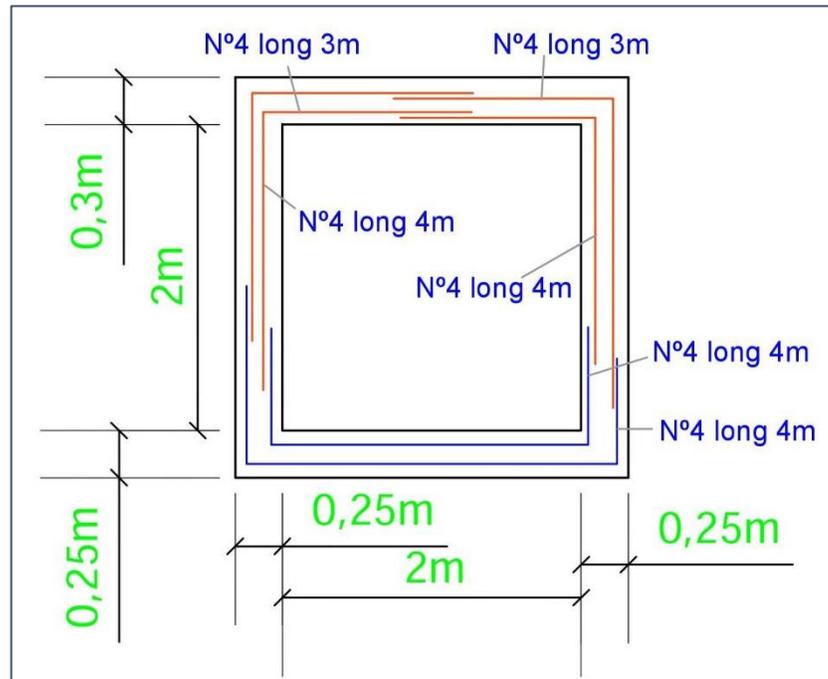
Detalle despiece box coulvert. Fuente propia
